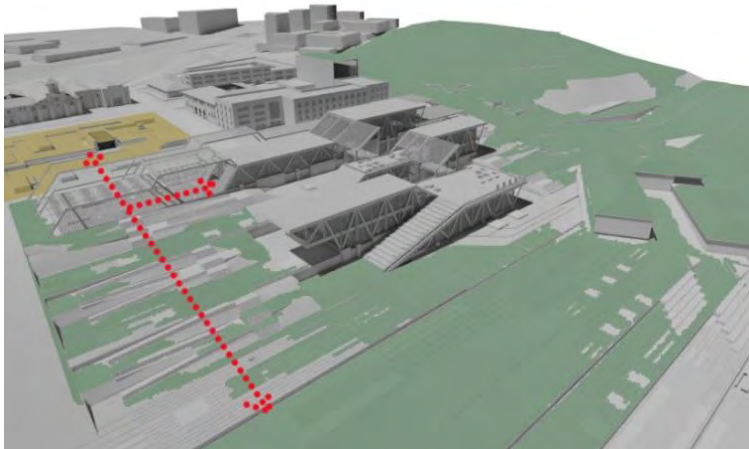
/Esquema planteamiento propuesta acceso/ elaboración propia
